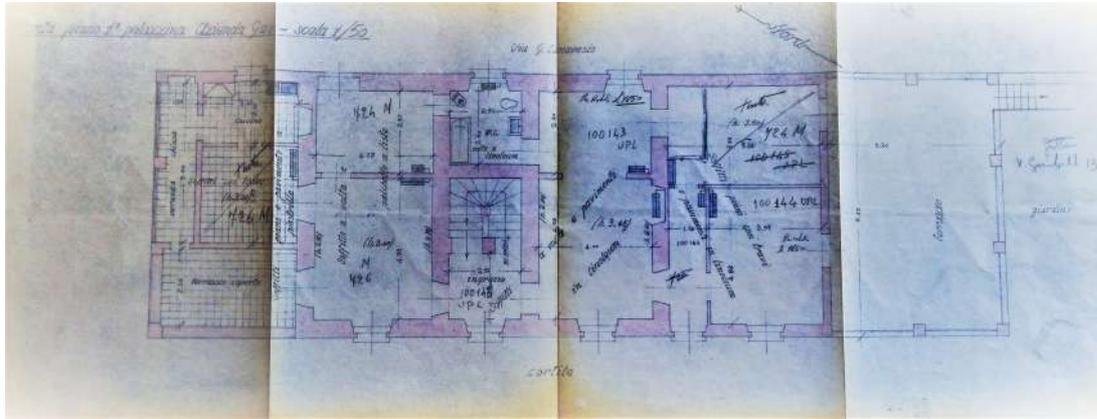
Pianta 1° piano palazzina Azienda Gas oggetto di intervento, 1955. (Attuale fabbricato B) (Pinerolo, Archivio storico della Città)
